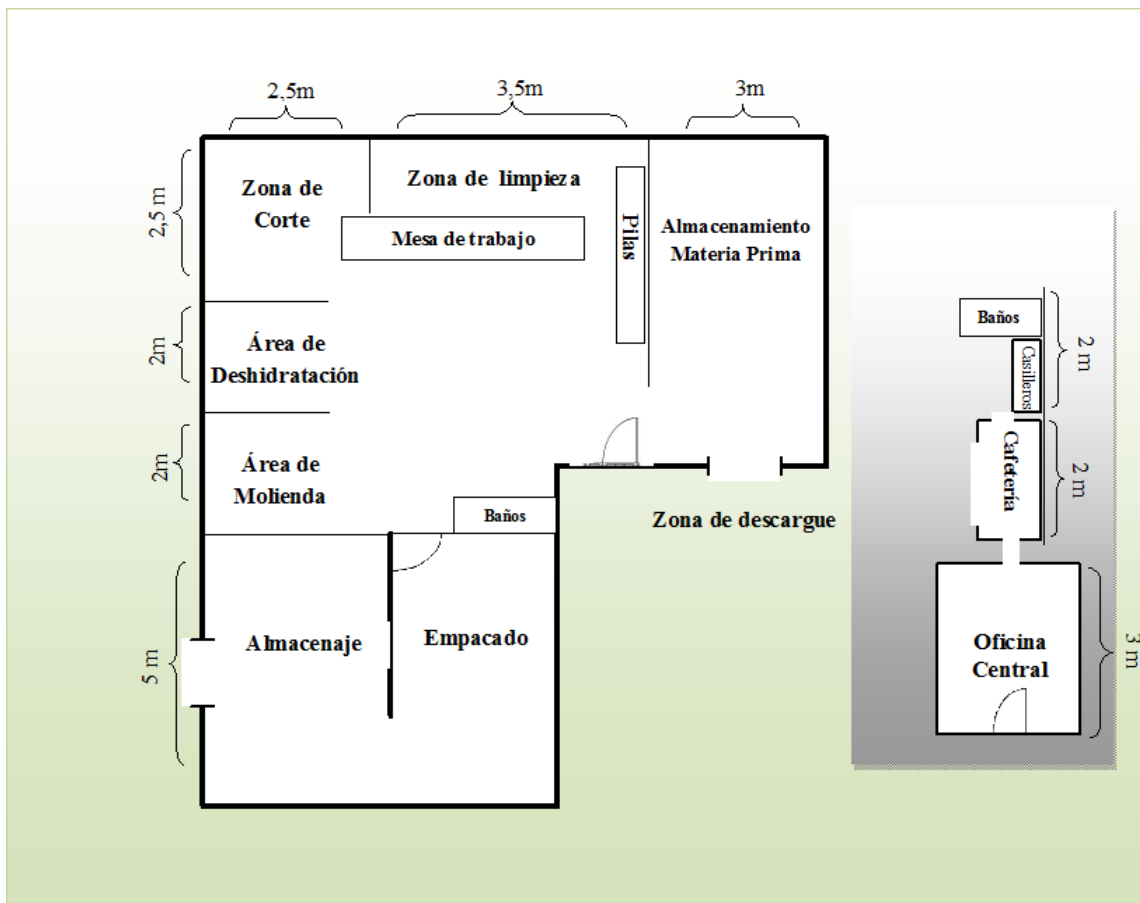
Diseño de planta y su distribución. Elaboración propia, 2016.
